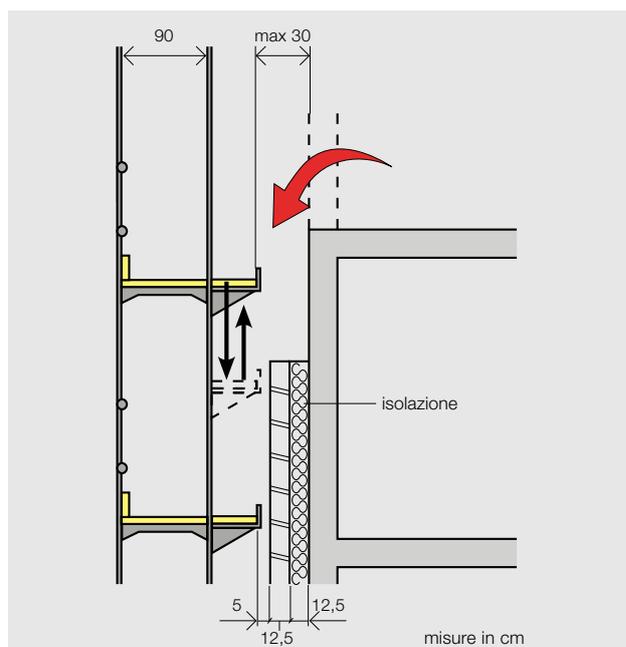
muratura a faccia vista realizzata successivamente ai lavori di costruzione
